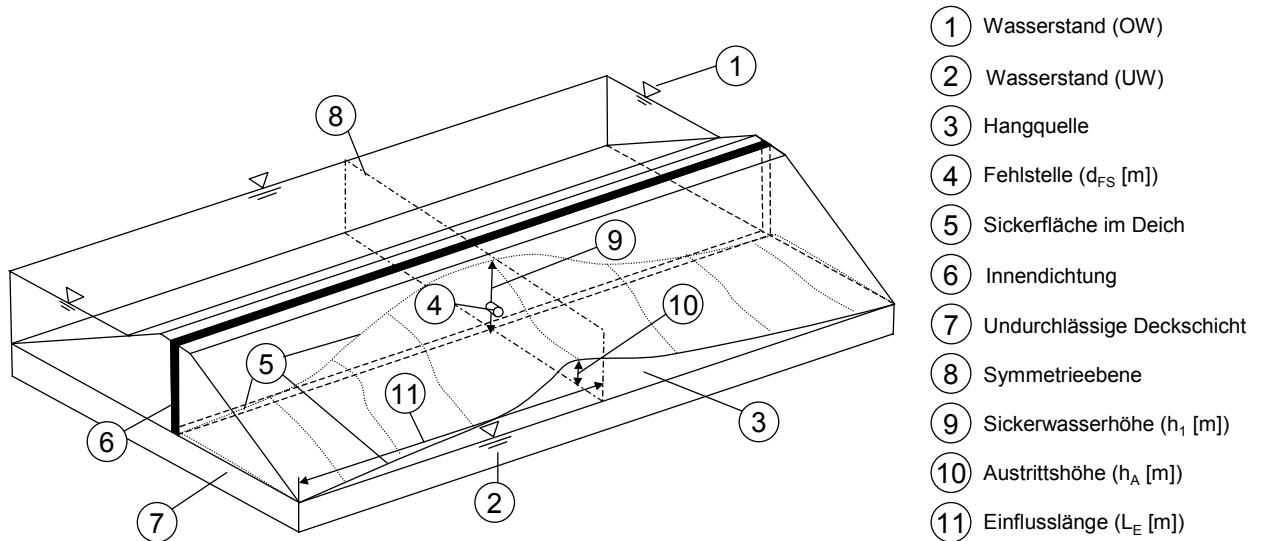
Skizze eines Deiches mit Innendichtung und Fehlstelle und der Sickerwasseroberfläche im unterwasserseitigen Deichkörper (aus HASELSTEINER 2007a)
